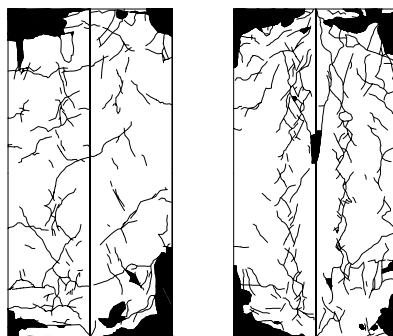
ひび割れ状況 (± 10 サイクル終了時)
